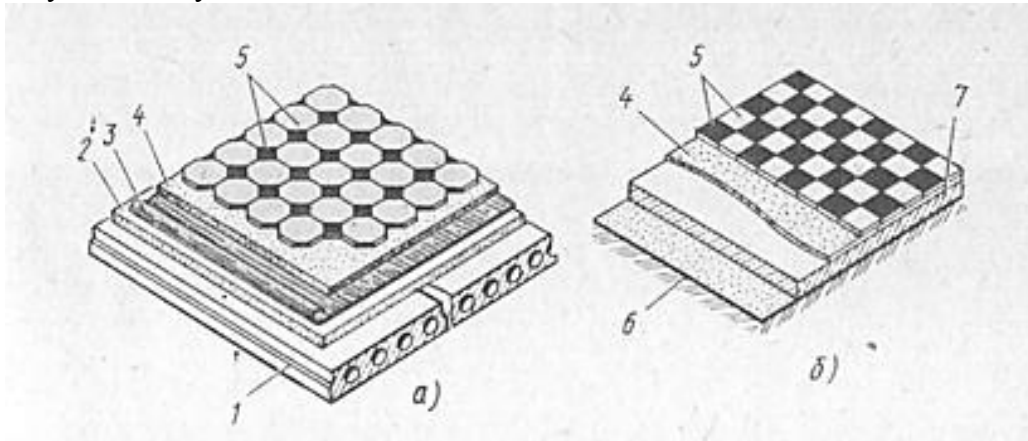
Конструктивні елементи підлог, влаштованих на перекритті (а) і на ґрунті (б): 1- залізобетонна плита, 2-підстилаючий шар (підготовка), 3 - рулонна гідроізоляція, 4 - прошарок, 5 - покриття, 6 - підстава (ущільнений ґрунт) , 7 - бетонна підготовка (підстильний шар)
